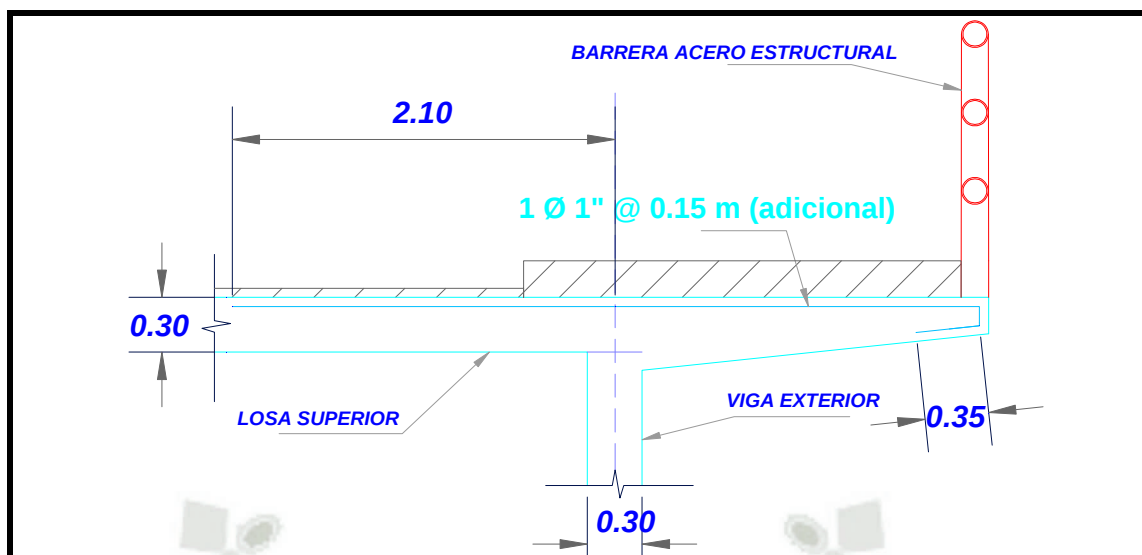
Diseño en Concreto Armado – Losa en Volado del Tablero de Puente
